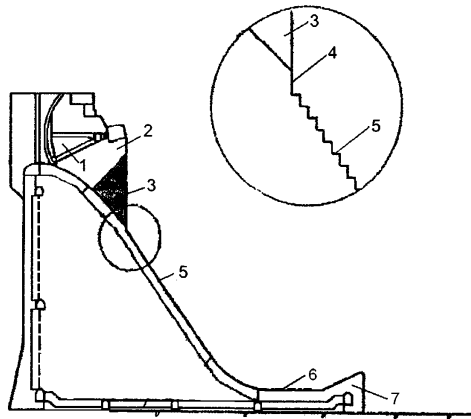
Продольный разрез по ступенчатой водосливной плотине и концевому устройству, которые рассчитаны на пропуск значительных удельных расходов:
